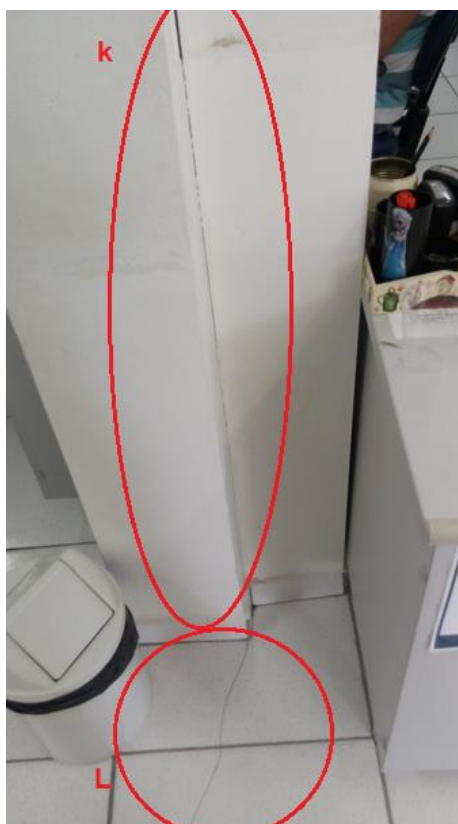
Encontro entre a base de madeira e elemento estrutural da área interna central
